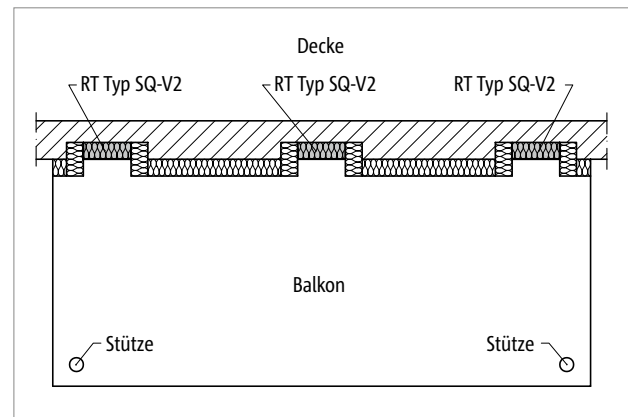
Schöck Isokorb® RT Typ SQ: Anschluss eines Balkons an eine Bestandsdecke, gestützte Konstruktion
